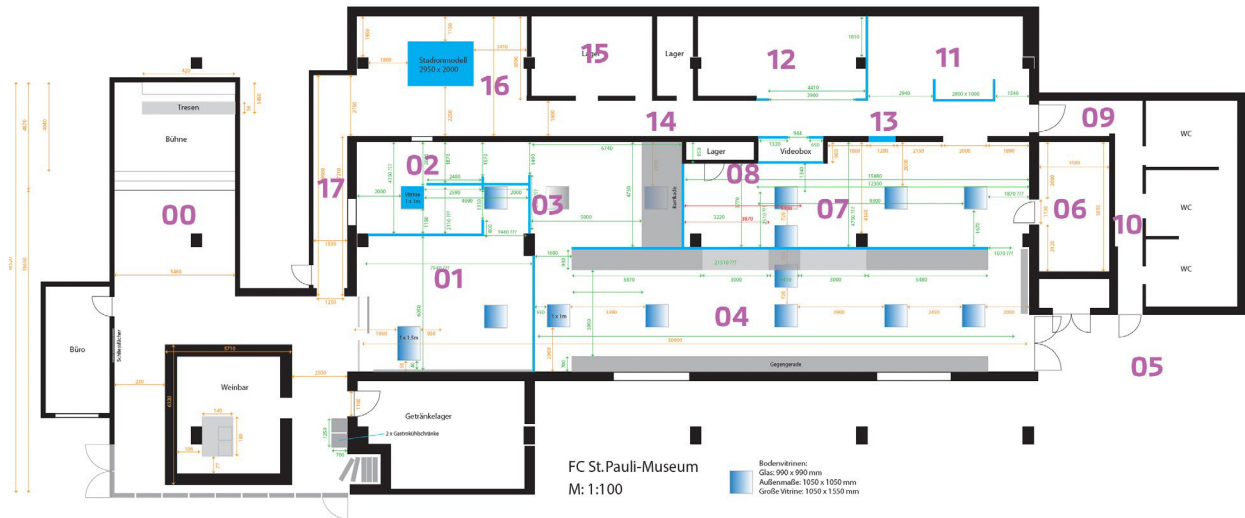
Grundriss des Museums mit nummerierten Bereichen
